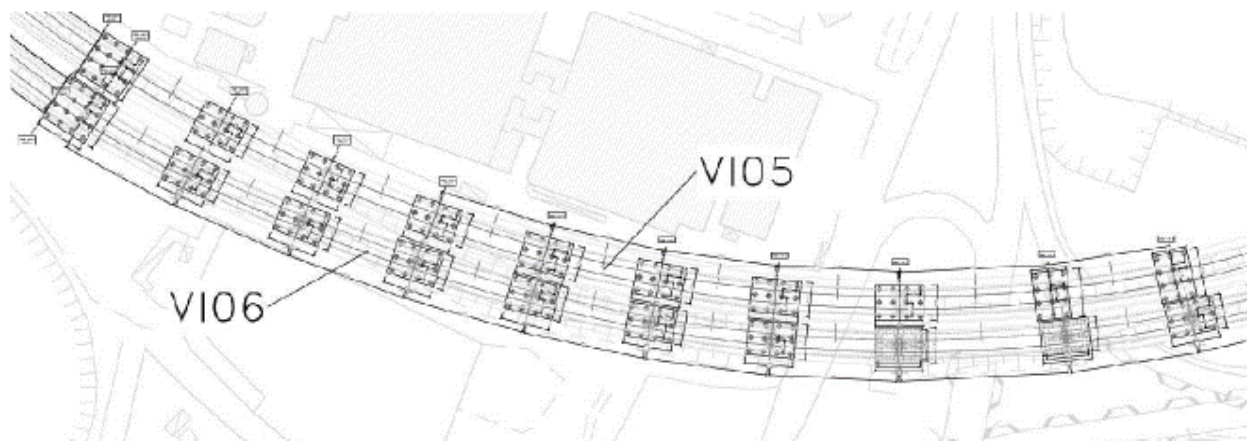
Planimetria dei viadotti VI05 (Lotto 3) e VI06 (Lotto 2)
